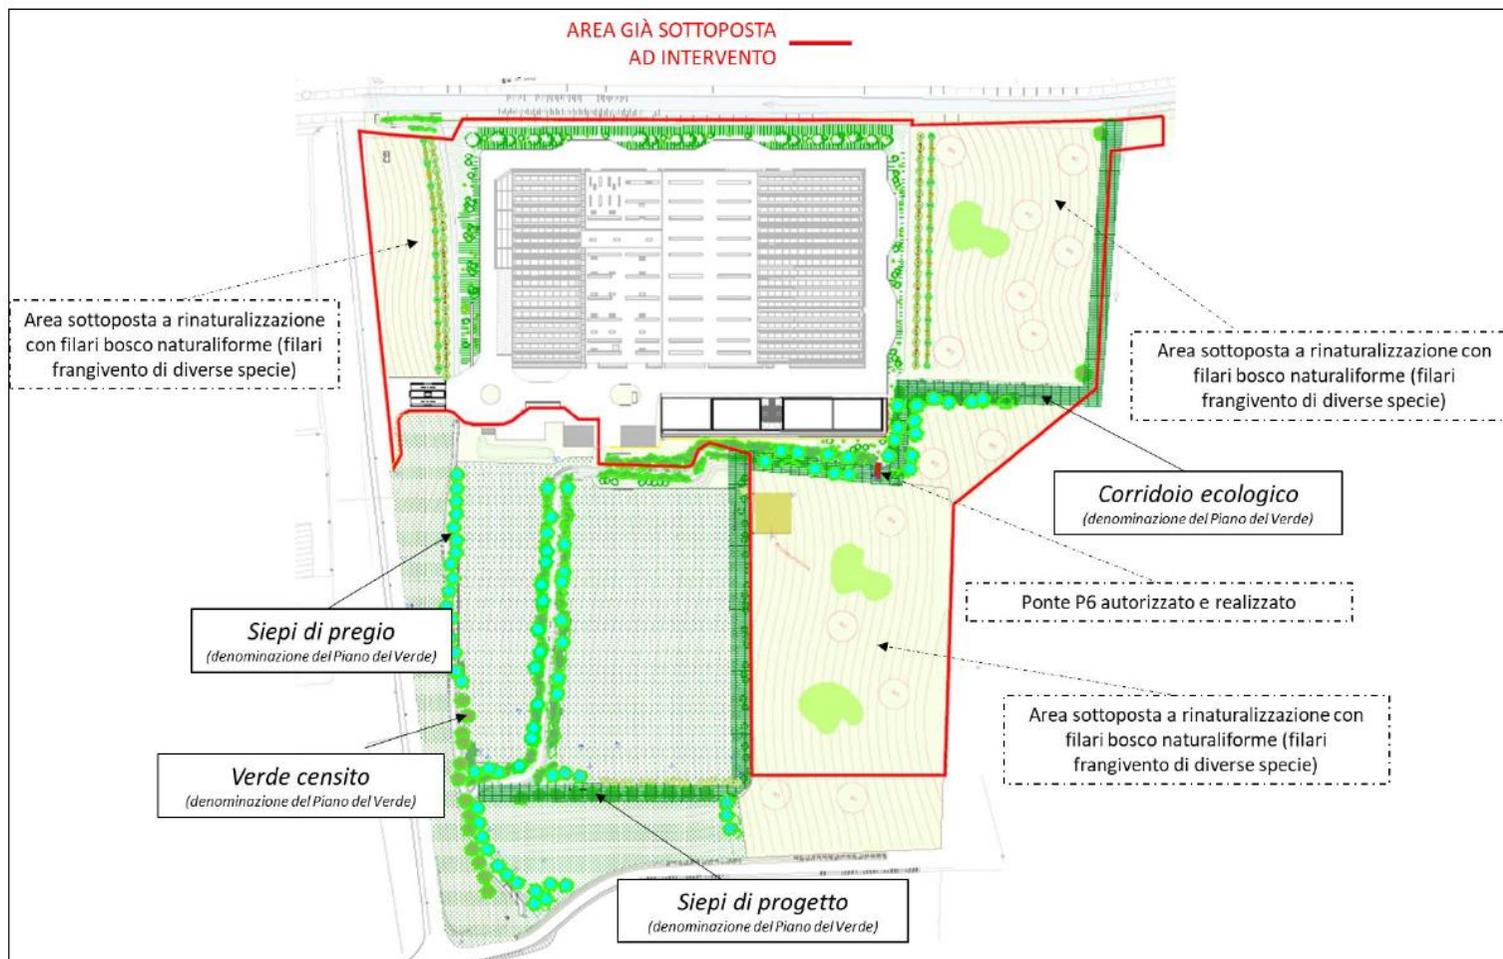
Stralcio planimetria stato attuale e indicazione interventi a verde secondo il Piano del Verde
